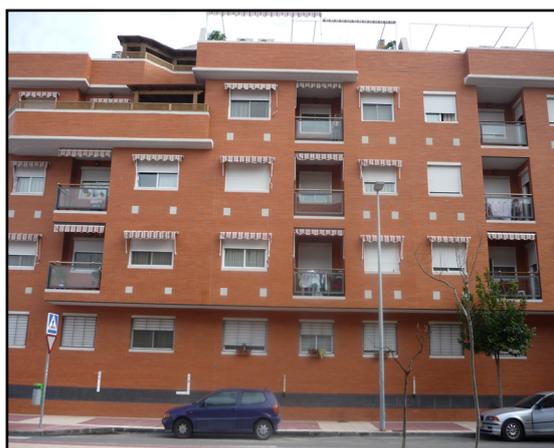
Fachada de ladrillo cara vista. La Flota. Murcia
